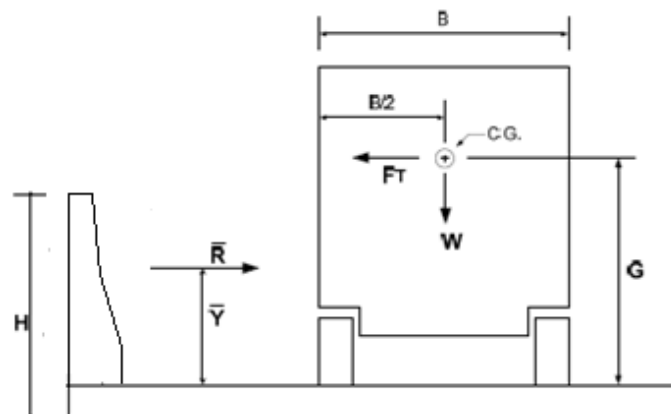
Cargas de diseño en protecciones laterales (parapeto de hormigón) [12]
